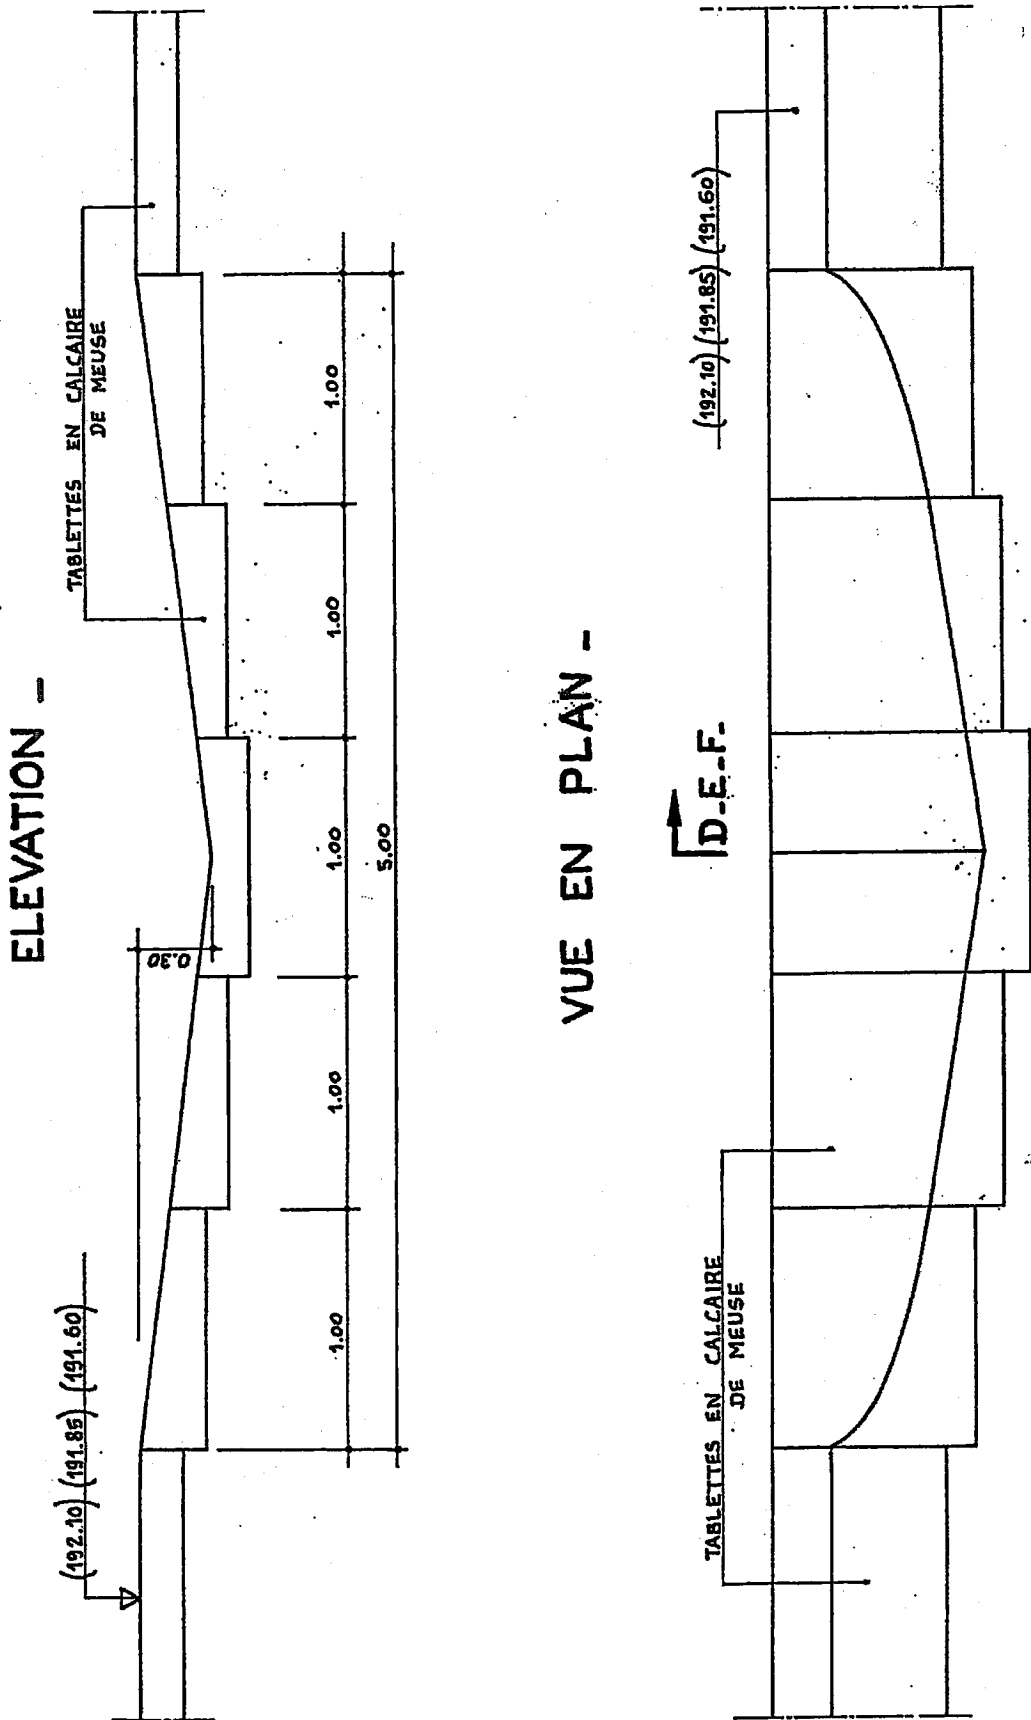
/4. Coupe en travers des échancrures en V dans les trois murs transversaux de l'échelle à poissons du nouveau barrage de Bardonwez (source du document: MET).
